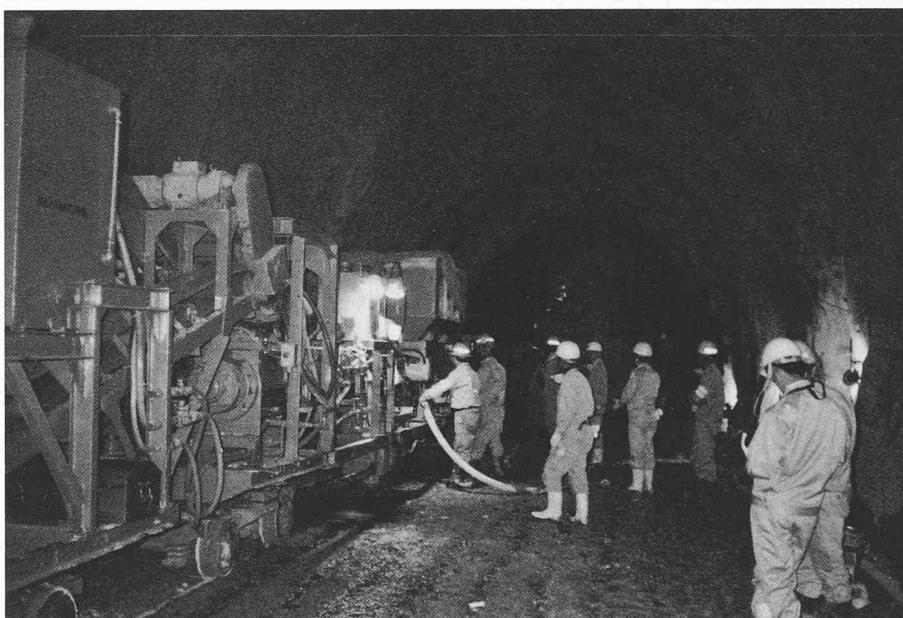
Japanische Tunnelbaustelle. Installation einer 40 m langen Spritzanlage für das Zweiwegverfahren
